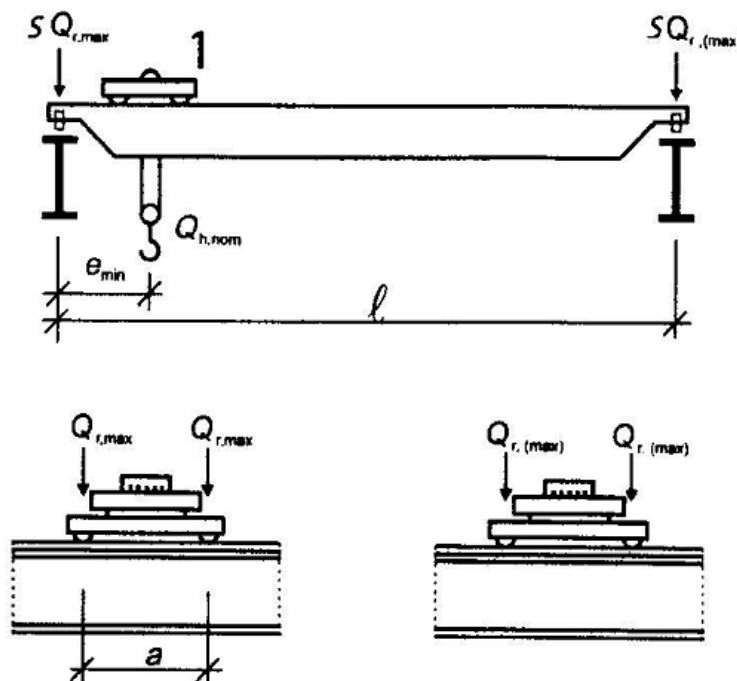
Charges verticales maximales sur la poutre de roulement
